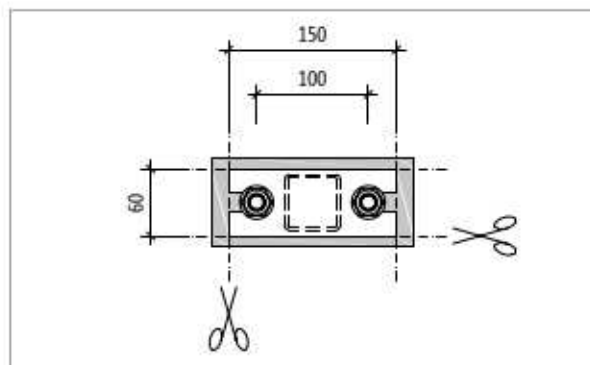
Schöck Isokorb® T Typ S-V: Maße nach Abschneiden des Dämmkörpers.
